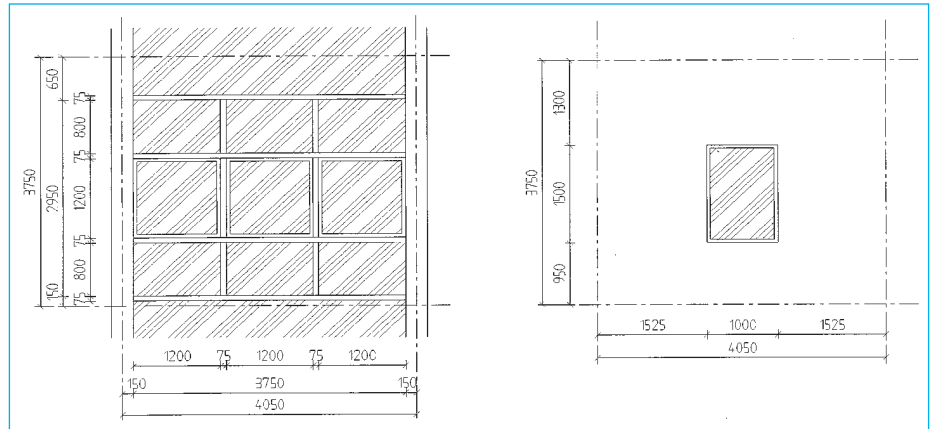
Zwei Varianten der Fassadengestaltung des Mustergebäudes links: Gebäude 1, Fassade mit Stütze/Riegelkonstruktion, voll verglast rechts: Gebäude 2, Fassade massiv, geringfügig verglast
